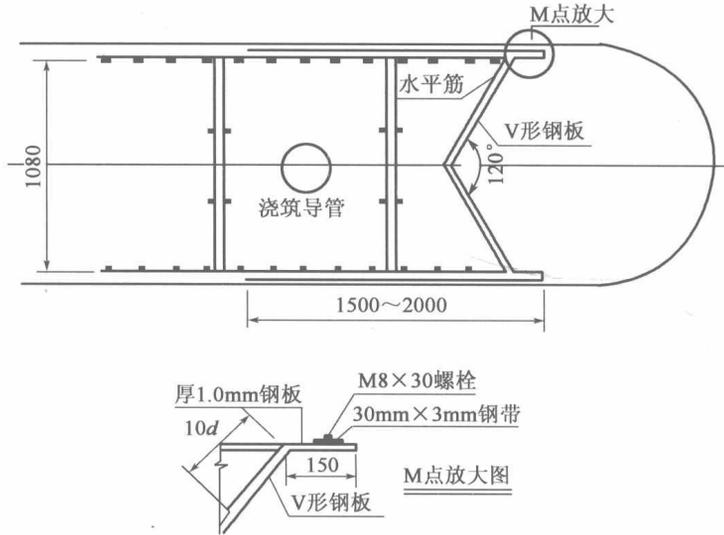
V形钢板断面结构图(尺寸单位:mm)
